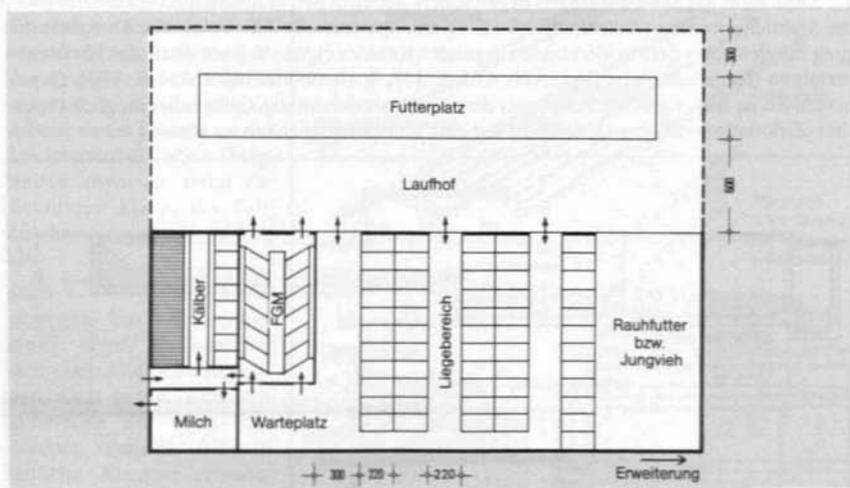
Grundform des Liegeboxenstalles mit Laufhof (Maße in cm)
